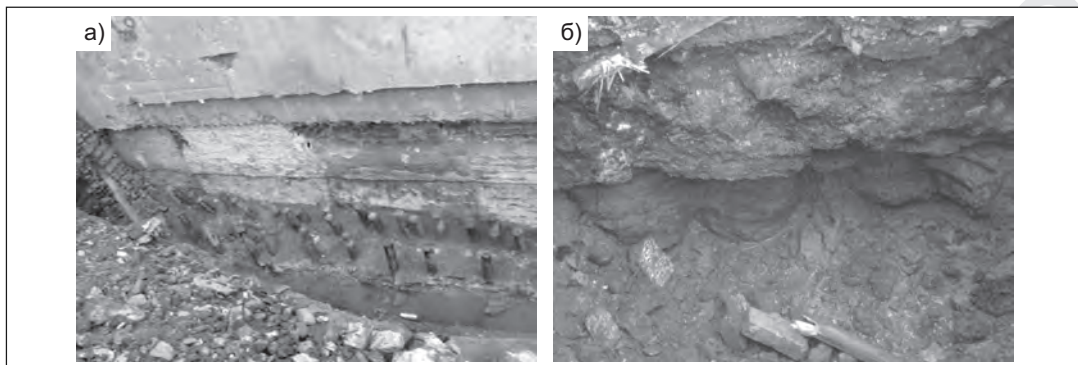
Закрепление грунта под фундаментами окружающих зданий: а — размещение вертикальных столбов закрепленного грунта, армированных металлическими трубами (см. рис. 9.31); б — контрольное вскрытие шурфов
